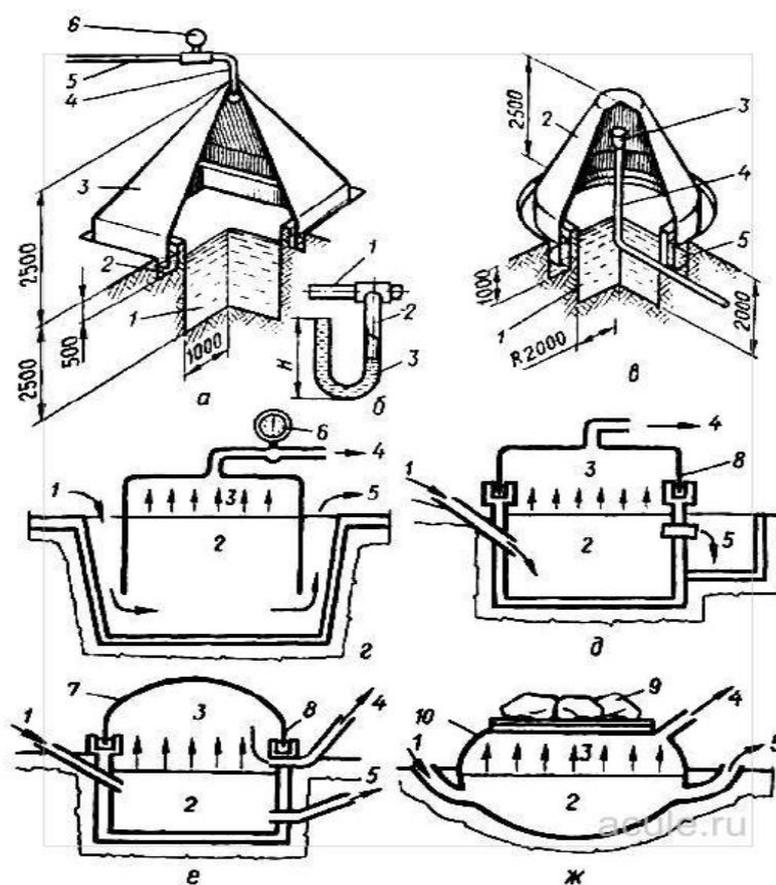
Схемы простейших малогабаритных биогазовых установок. а) с пирамидальным куполом: 1 - яма для сырья; 2 - канава гидрозатвора; 3 - колокол для сбора биогаза; 4,5 - патрубок для удаления биогаза; 6 - манометр.
